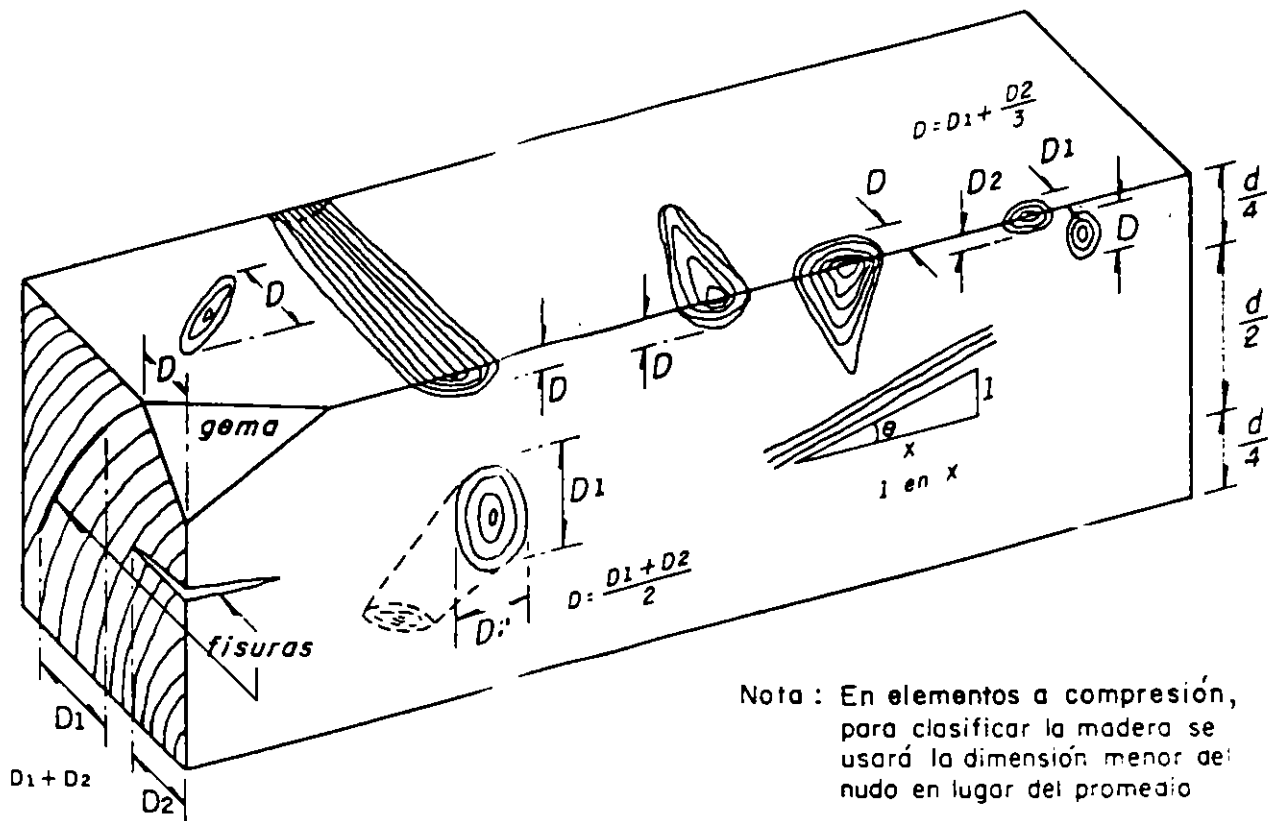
Fig I . Zonas en un elemento a flexión, para su clasificación estructural
